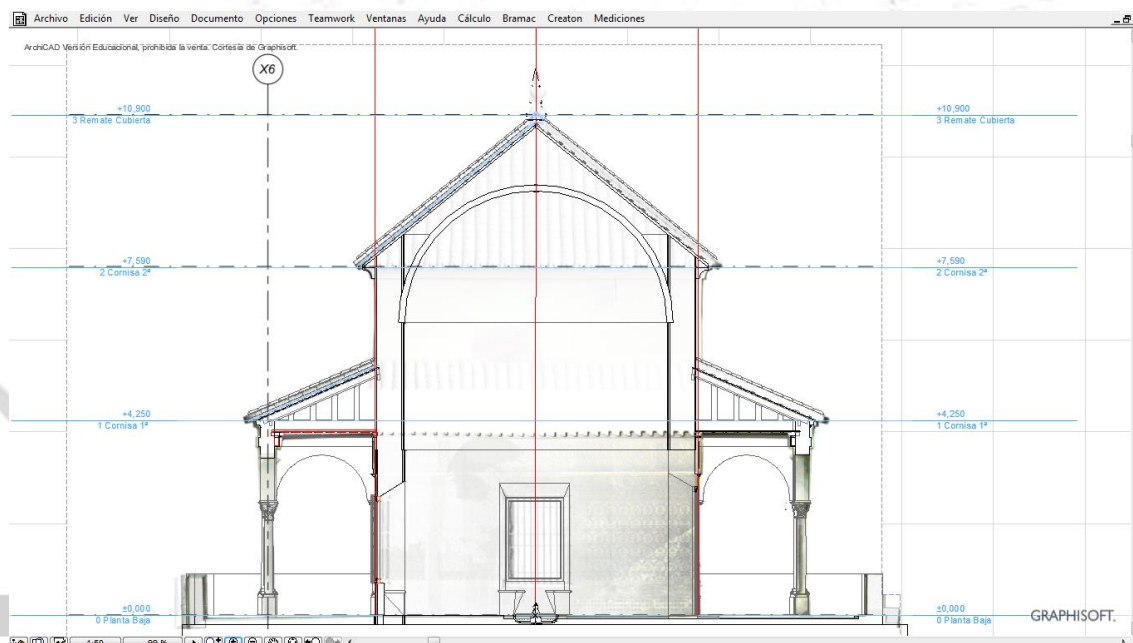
Sección hacia el Norte contrastando los planos de muros con la referencia de la nube de puntos.
